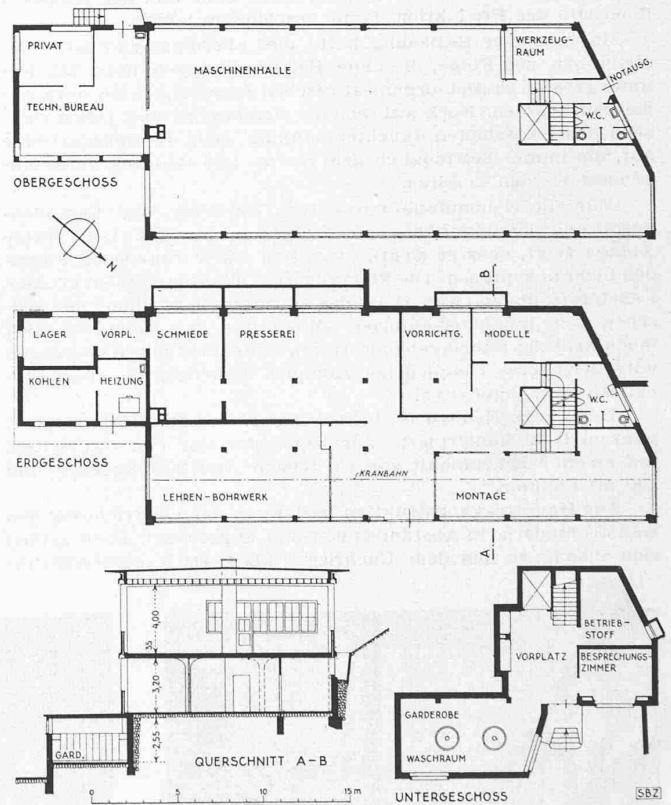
Grundrisse und Schnitt 1 : 400
